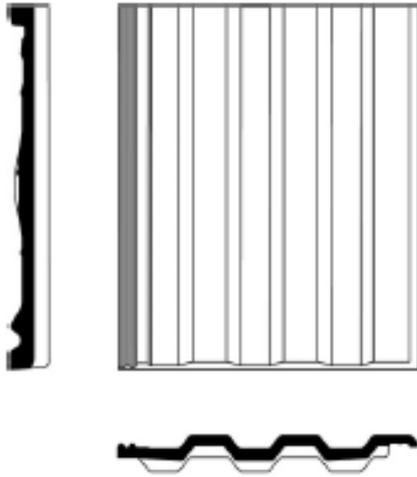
Betondachstein, 10-er Format, niedrig profiliert
